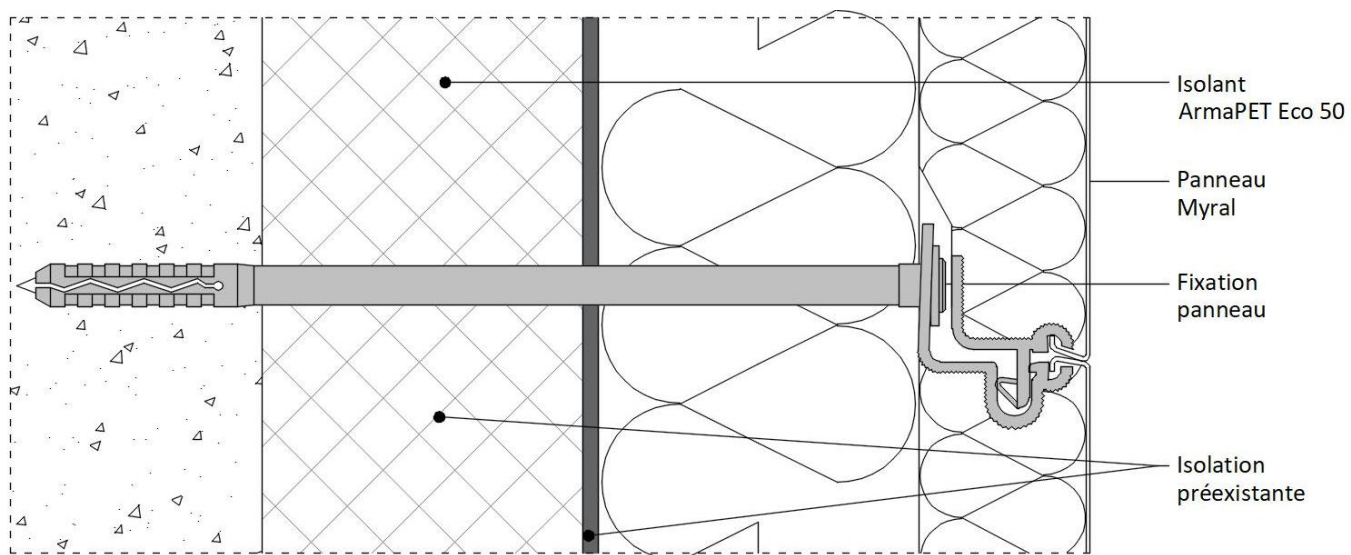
Pose sur ancienne ITE, lame horizontale (coupe verticale)
